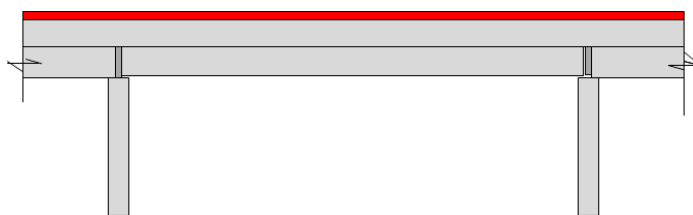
Støpeasfalt eller høyfast mørtel rett på elementer
